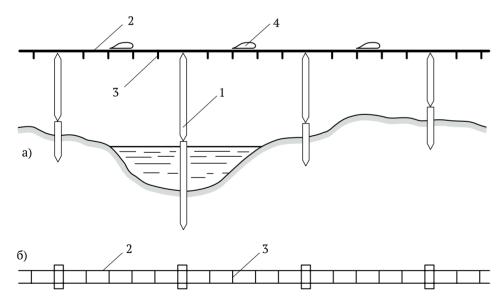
Схема размещения поперечных планок по длине трассы: а – вид сбоку на СТС; б – вид сверху на СТС; 1 – поддерживающая опора; 2 – рельс; 3 –поперечная планка; 4 – транспортный модуль
